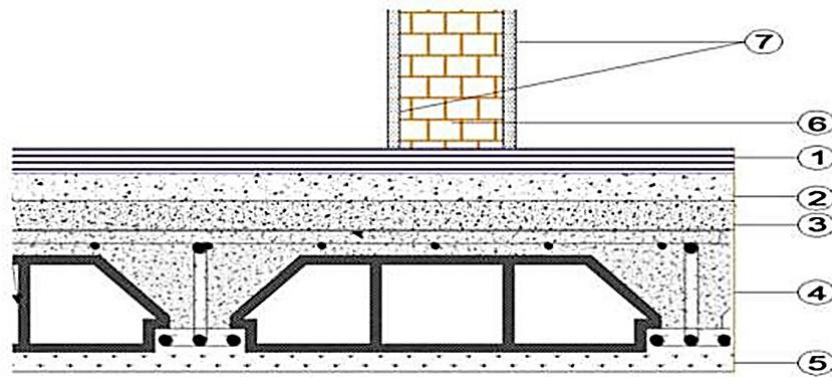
Coupe verticale du plancher étage courant en corps creux
